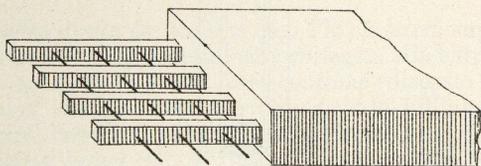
Lastra in béton armato, sistema Hyatt.
